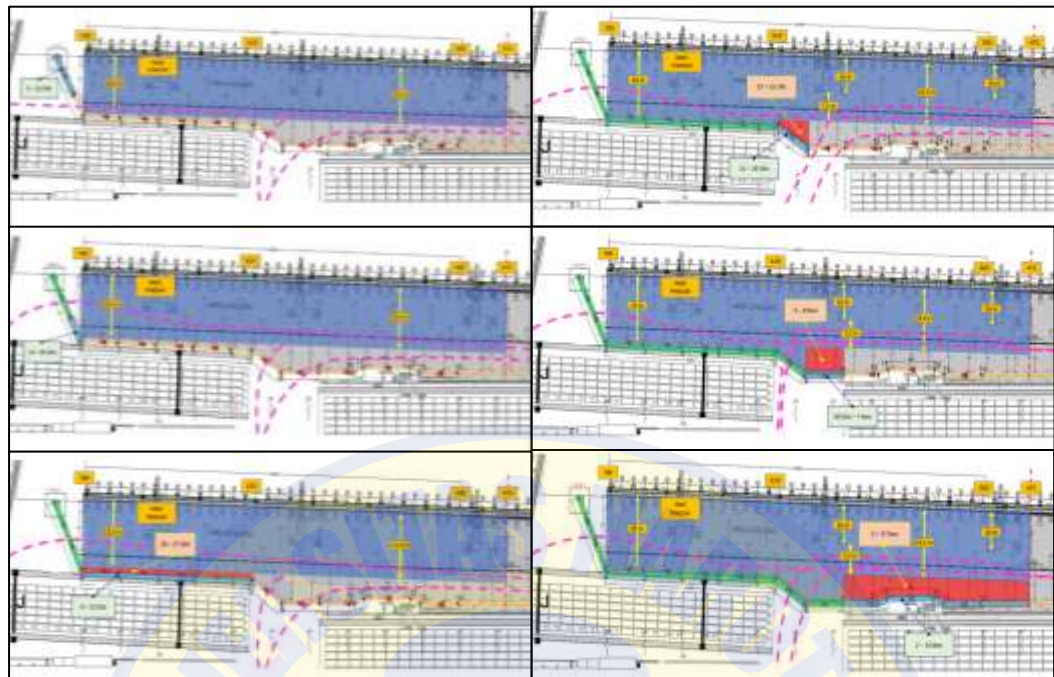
Site Layout Proyek Dermaga Berlian
